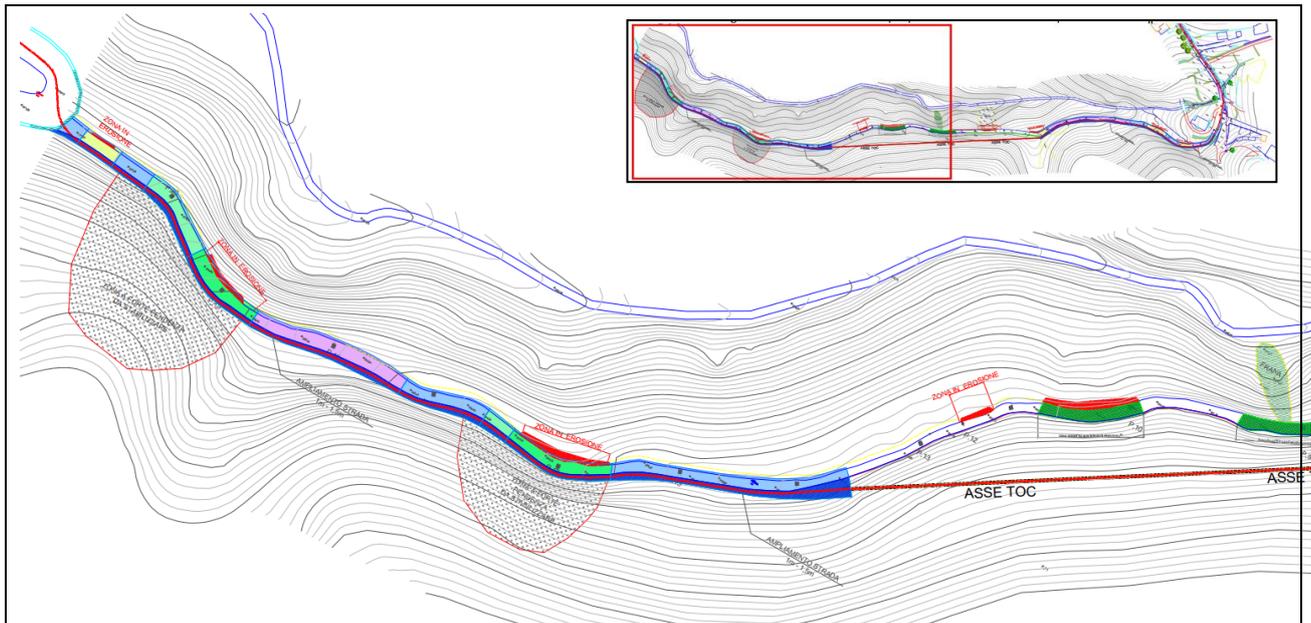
Planimetria con indicazione delle tipologie di intervento. Legenda in Figura 10 e Figura 11
